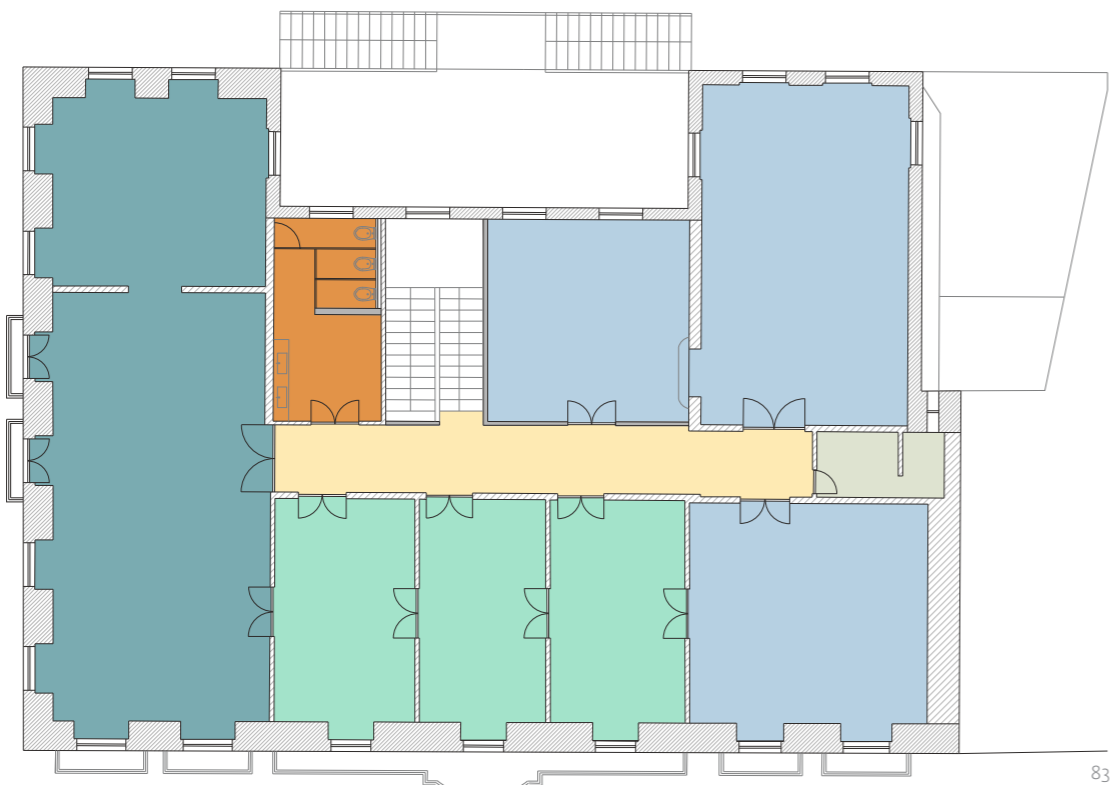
Proposta em planta para o piso superior (2) à escala 1/200.
